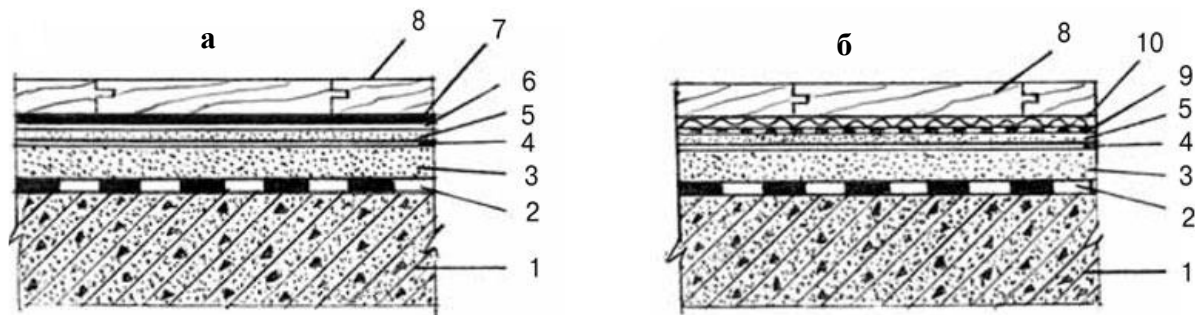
Схема конструкції підлоги з паркетної дошки: а – метод приклеювання до основи; б – «плаваючий» метод; 1 – залізобетонна плита перекриття; 2 – гідроізоляція; 3 – стяжка; 4 – емульсія-ґрунт під шпаклівку; 5 – саморозтікаюча шпаклівка; 6 – ґрунтовка під клей; 7 – паркетний клей; 8 – паркетна дошка; 9 – вологоізоляційна плівка; 10 – еластична паро- і звукоізоляційна підкладка
